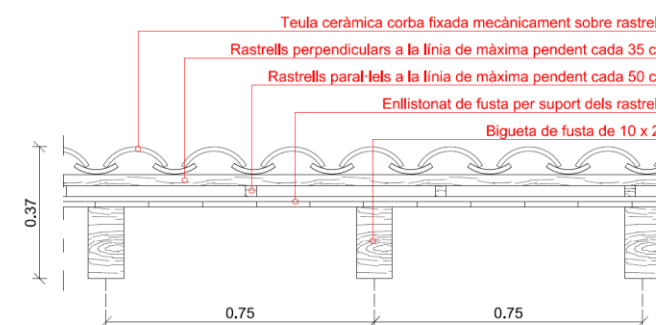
Secció constructiva sostre porxo de planta baixa
